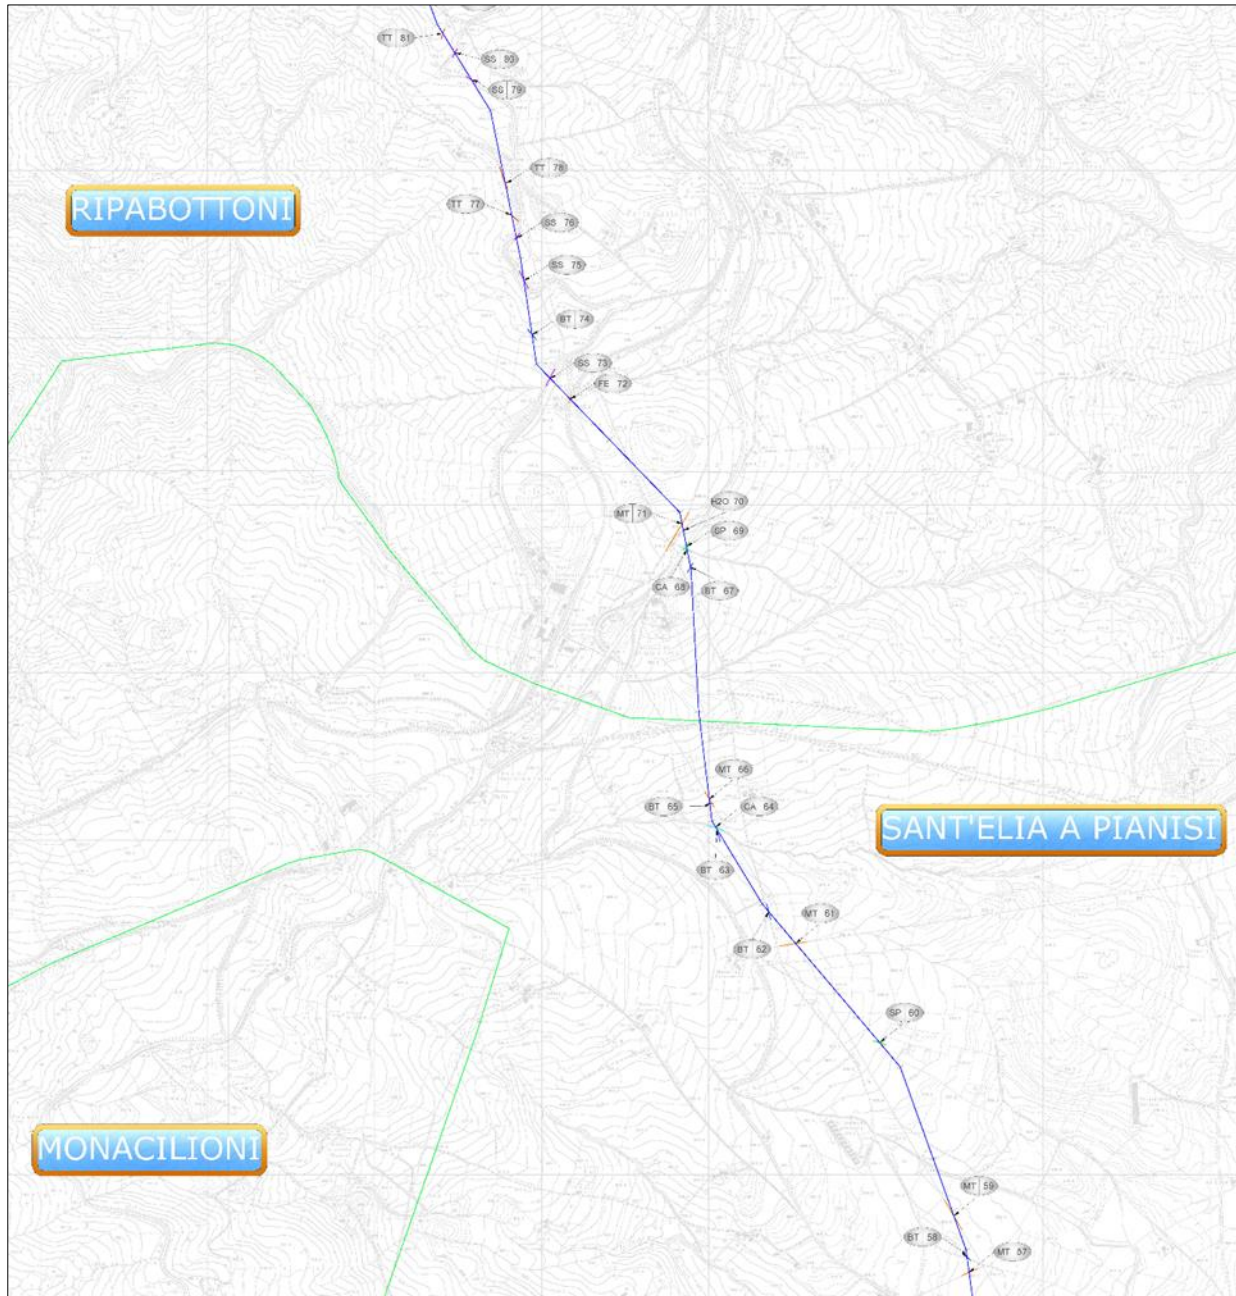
Stralcio planimetria tracciato elettrodotto su CTR (4/5)
